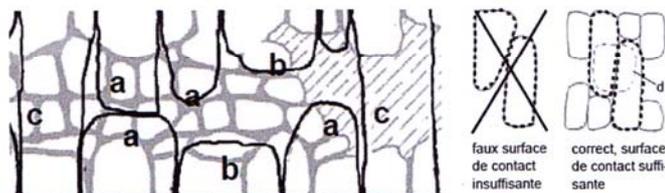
Pierres de boutisse : a. Pierres de liaison remplaçant une boutisse, b. Autres pierres de construction, c. Boutisses traversantes (©FSMPS, 2004).
